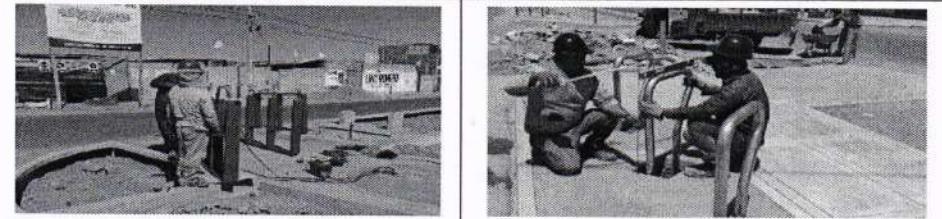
y 04: Colocación de encofrado para el vaciado de sardineles de baranda en ciclovía
